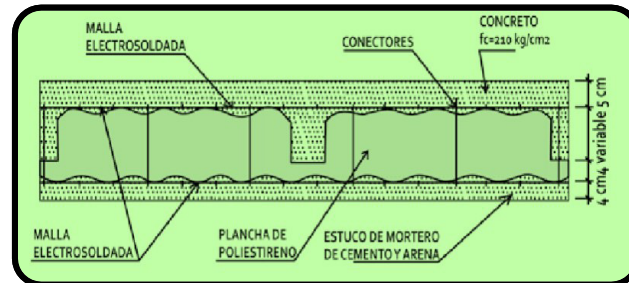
Panel losa con una nervadura para armado de viga (PL1).
